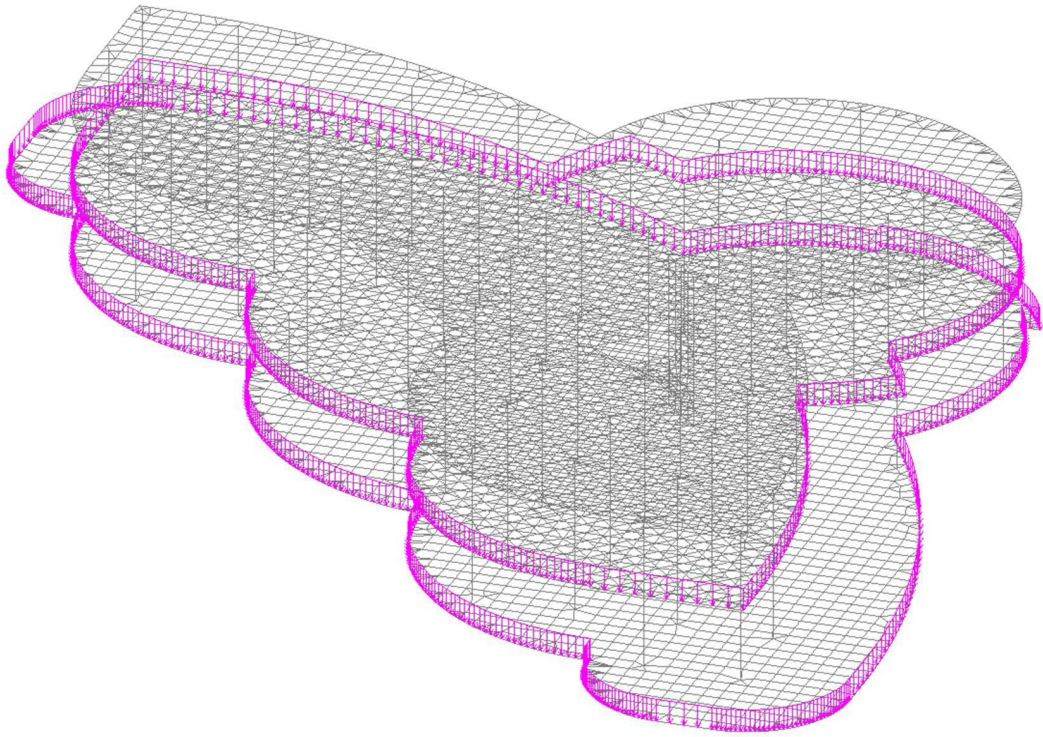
Схеми завантажень будівлі від ваги огороджувальних конструкцій
